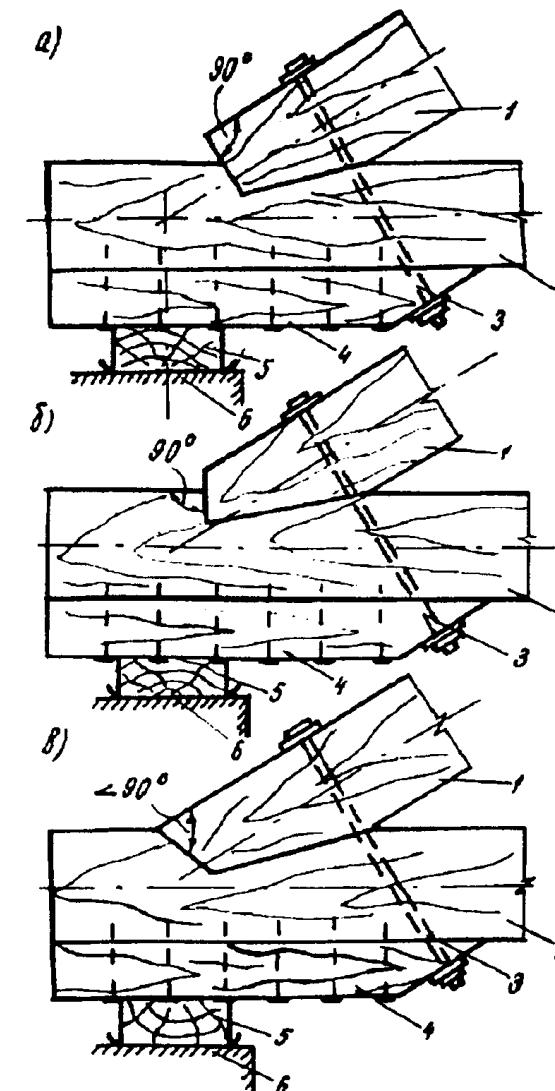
Правильное (а) и неправильное (б) и (в) выполнение узлов соединения деревянных элементов в лобовых врубках:
